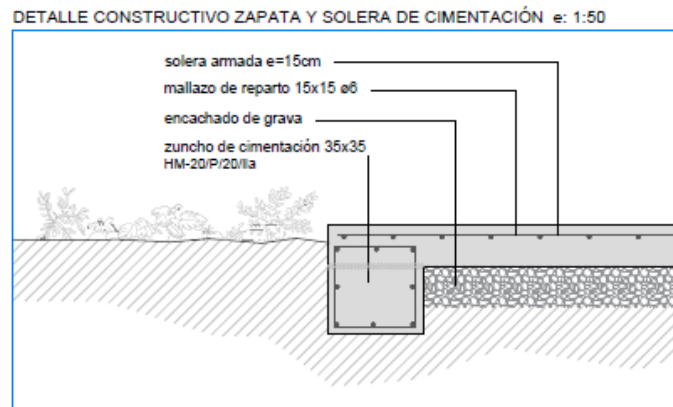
Detalle de la zapata y la solera de cimentación. Fuente: Creación propia.
